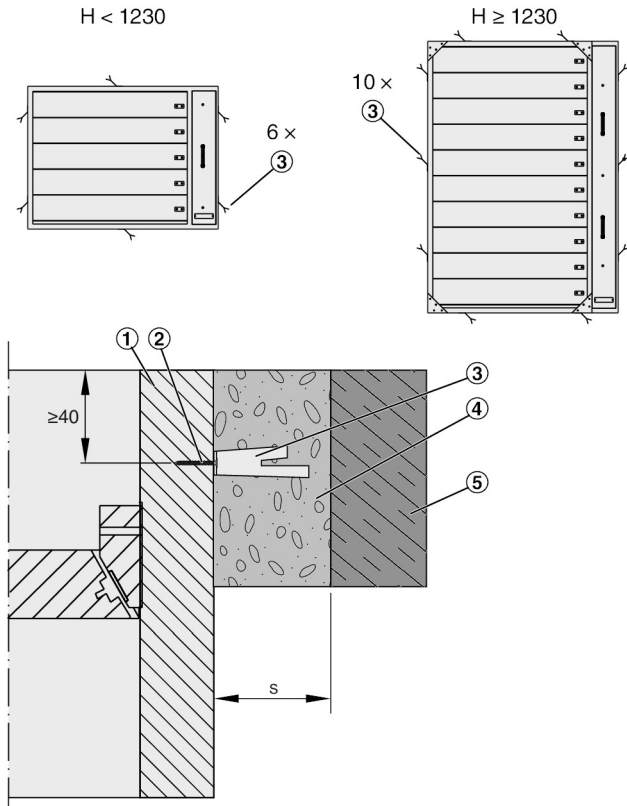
EK-JZ-Nasseinbau mit Maueranker
